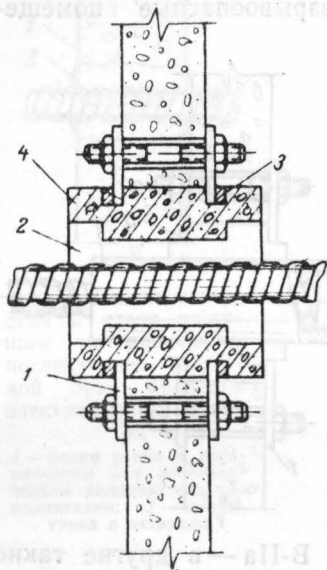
Защита отверстия в стене при пропуске электрического кабеля с помощью бетонных плит без гильз
